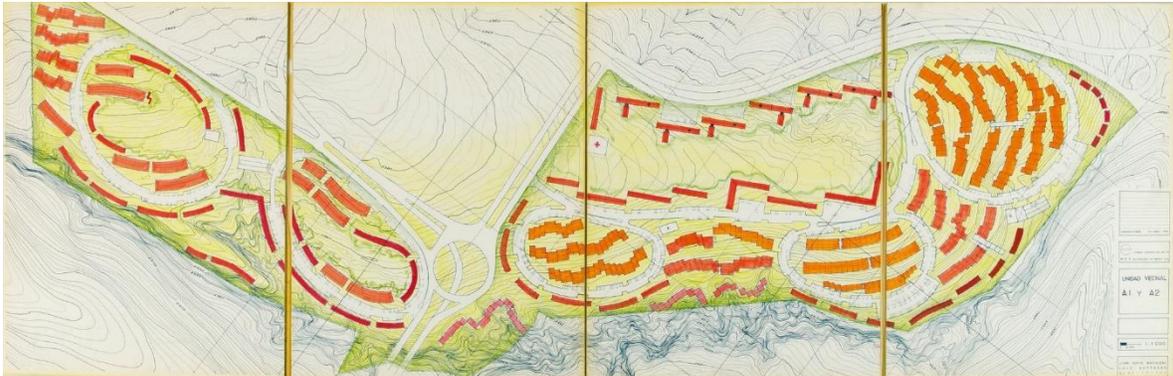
Planta Unidad Vecinal A1 y A2 del Plan Maestro preliminar de Lomas Verdes, del 20 de abril de 1965. Fuente: Fundación Barragán.
